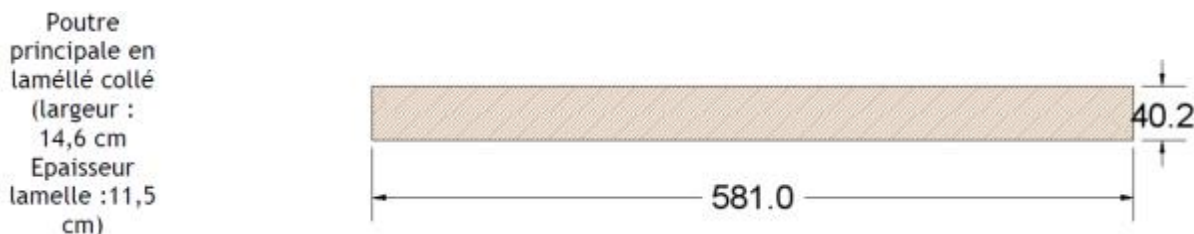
Caractéristiques de la poutre (poutre 3) de l'angle sud-est
